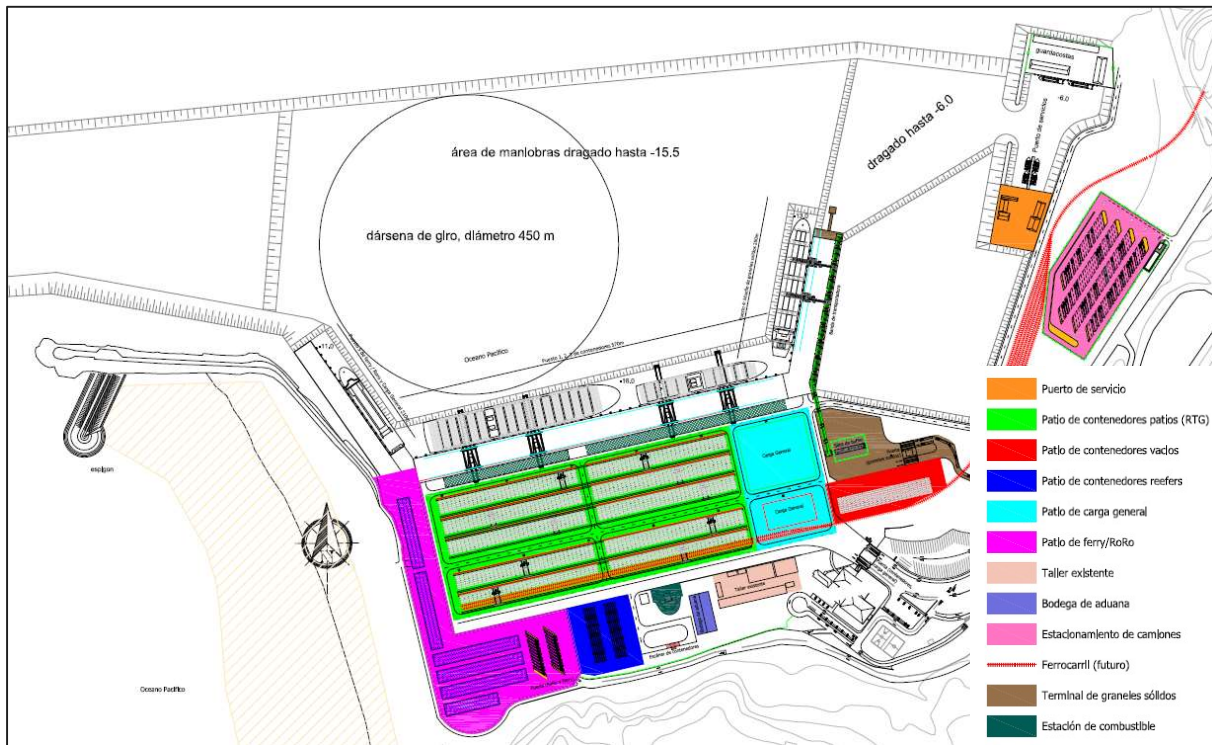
Plan Maestro de puerto Caldera Fase B
